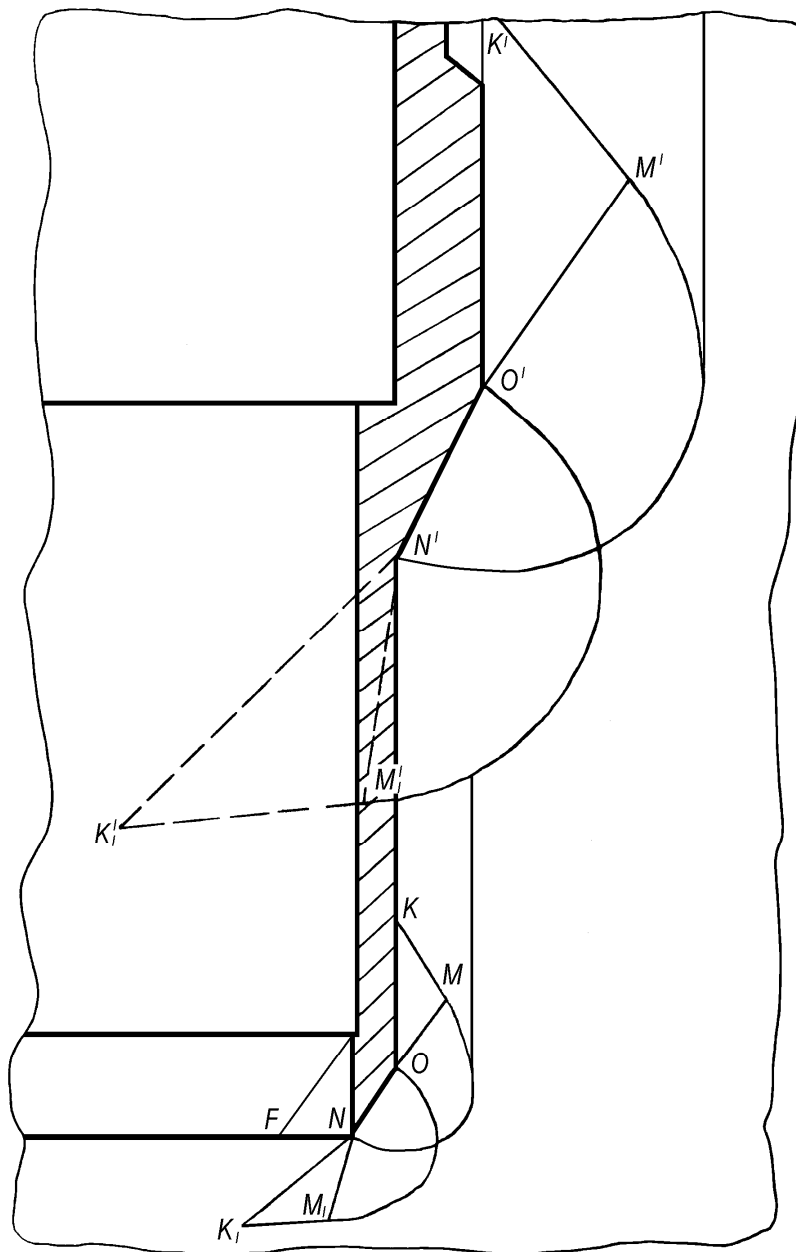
Схема развития областей нарушения грунта при вдавливании грунтоприёмной гильзы с двухступенчатой конусной наружной поверхностью башмака
